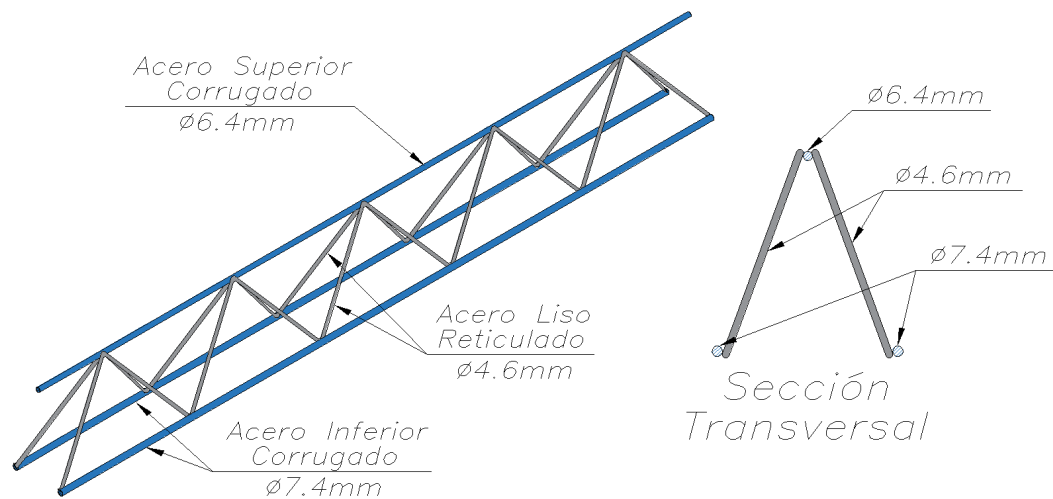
Detalle de los Aceros que Conforman el Tralicho.
